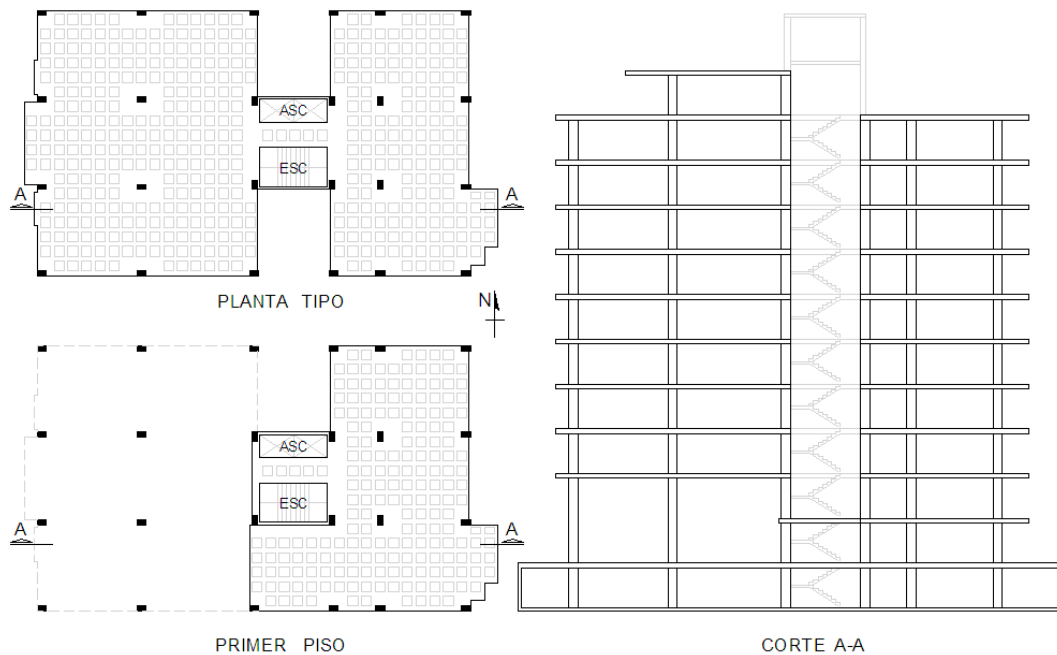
Edificio San José, plantas y corte de la estructura según proyecto original, adaptado de (Hanson & Degenkolb, 1969)
